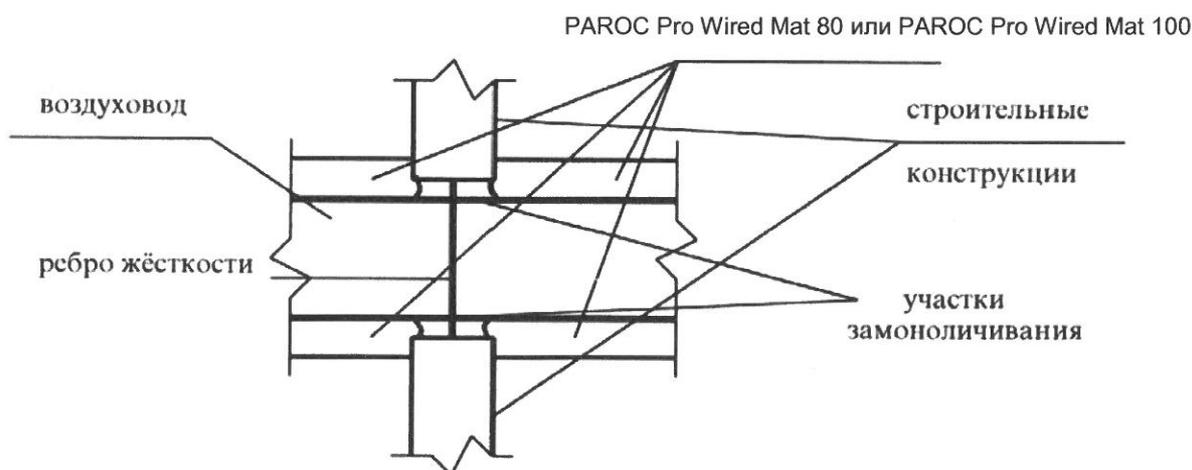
Принципиальная схема пересечения воздухопроводом строительной конструкции
